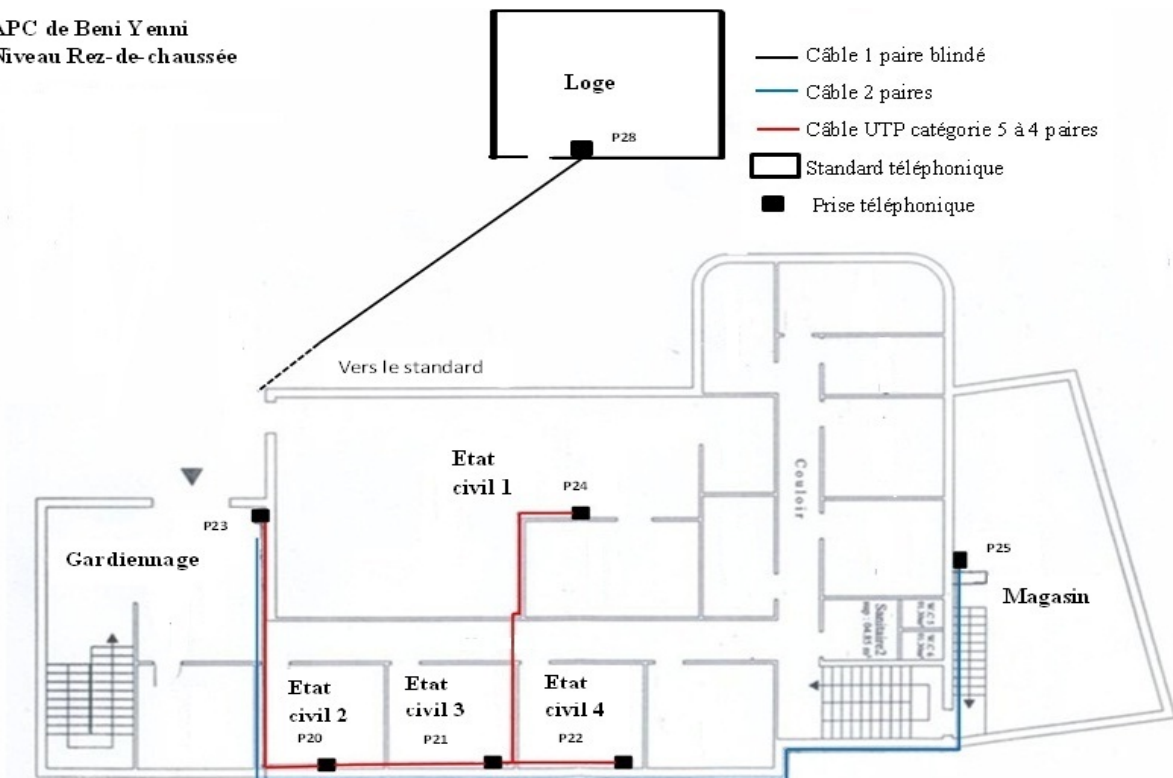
Plan du rez-de-chaussée de l'APC de Beni Yenni
